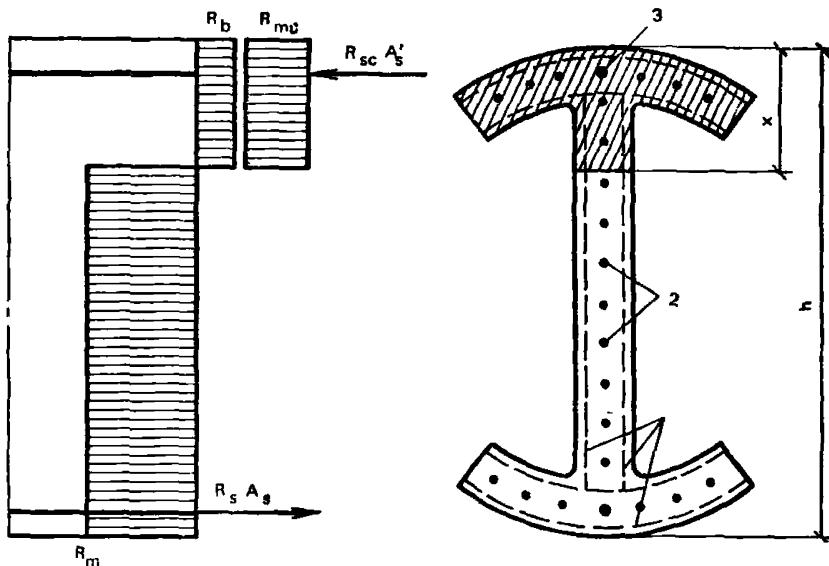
Схема внутренних усилий и эпюра напряжений в сечении, нормальному к продольной оси элемента, при расчете на прочность
